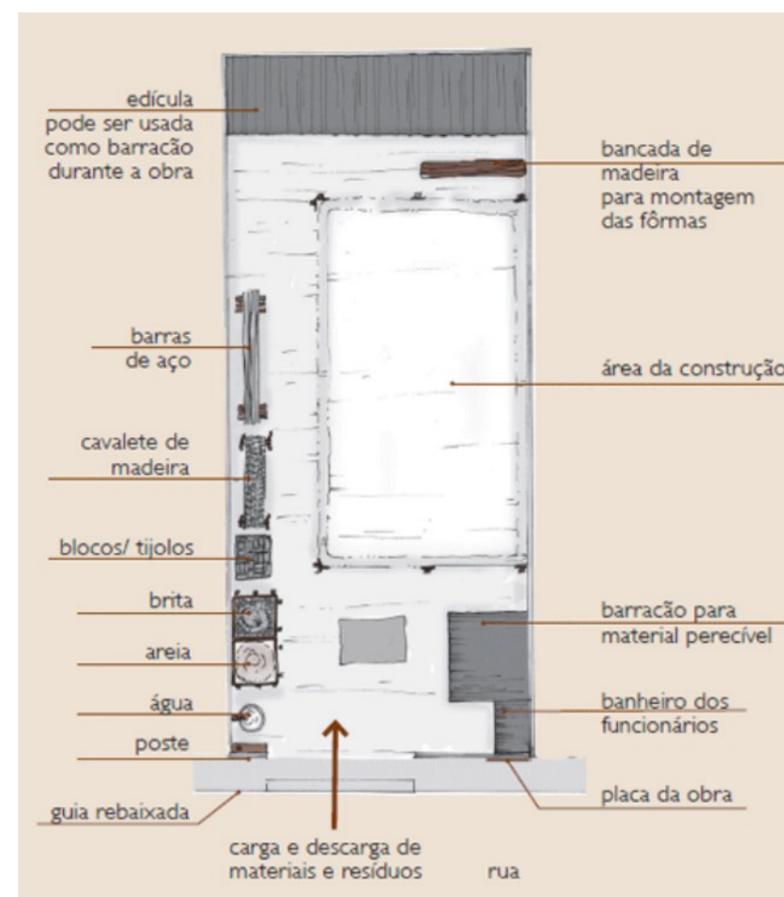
Modelo de canteiro de obras padrão. Planta esquemática. FONTE: Senço (1997).
